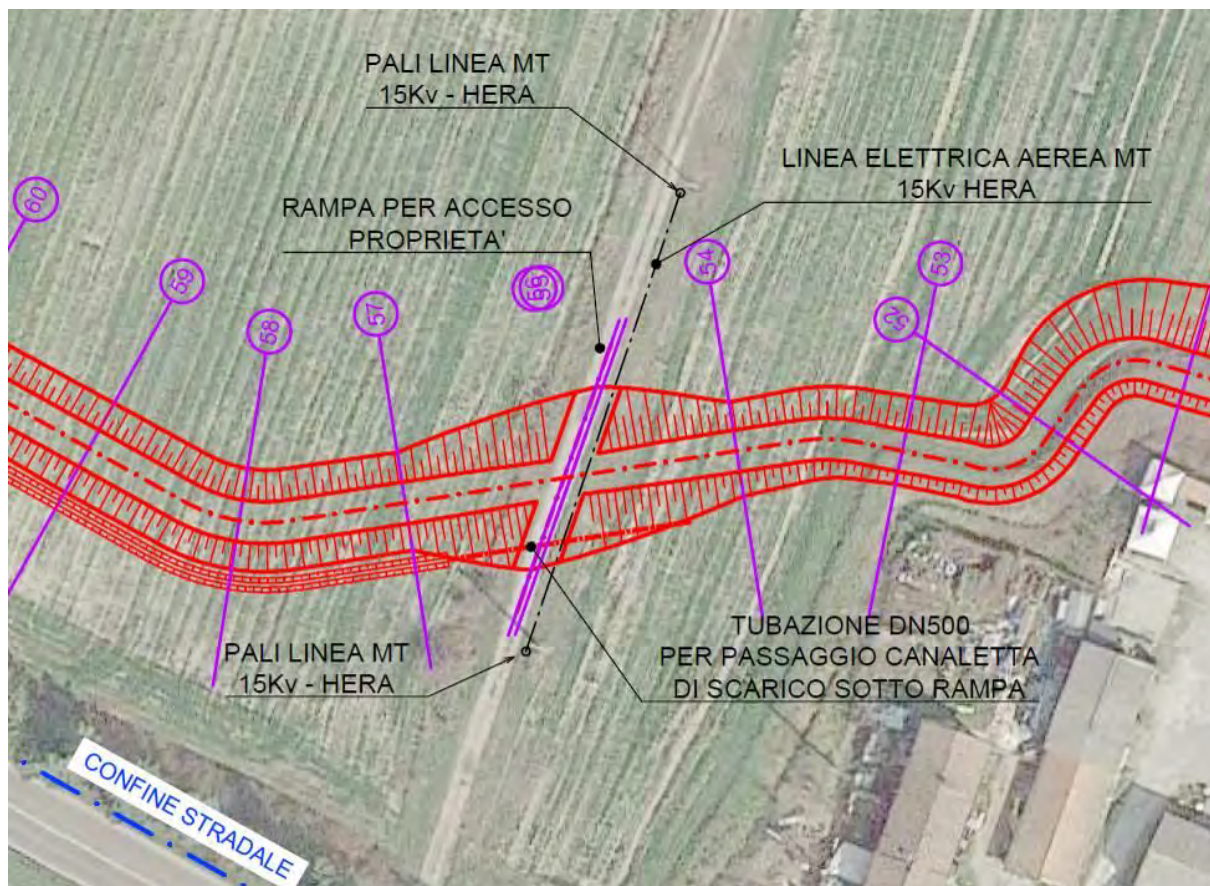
posizione linea elettrica aerea e piloni di sostegno (stralcio planimetria di progetto).
